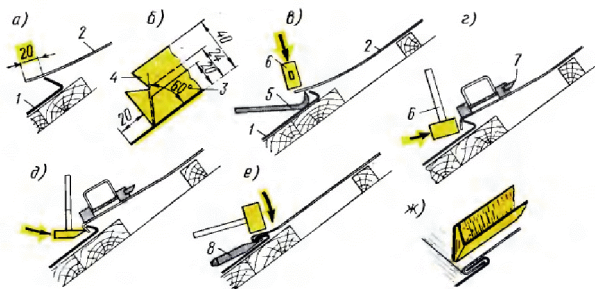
Соединение рядового покрытия с кромкой настенного желоба:
